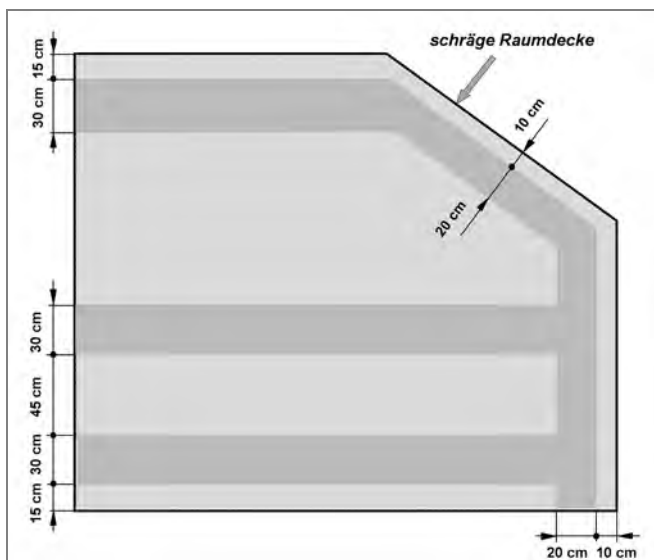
Grün markierte Installationszonen unterhalb von Dachschrägen
